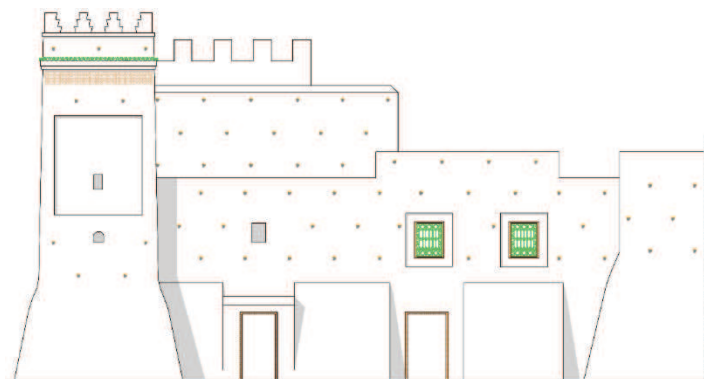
Façade du Dwayriyyet Ahl El-Abd, (échelle : 1/200).
